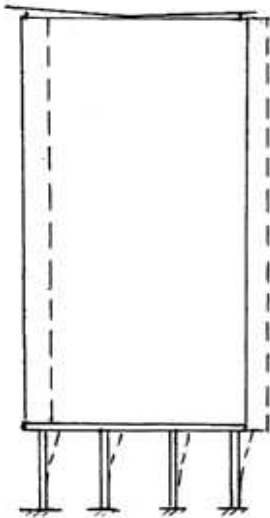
Схема будівлі з першим гнучким поверхом
